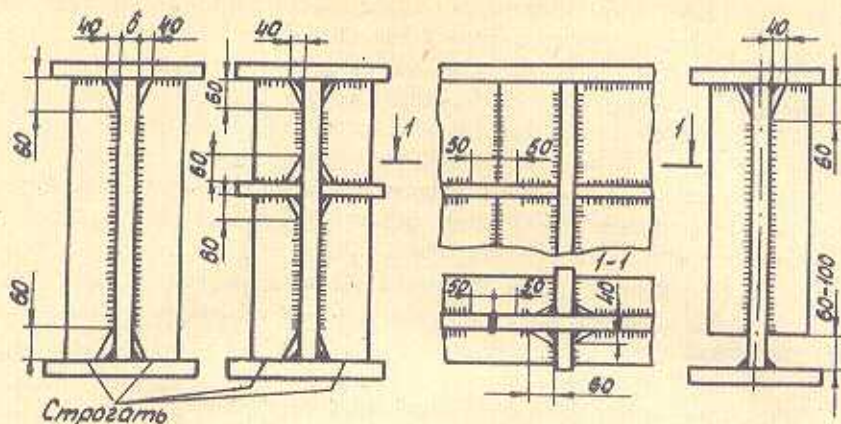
Схемы укрепления стенок балок поперечными и продольными ребрами жесткости
